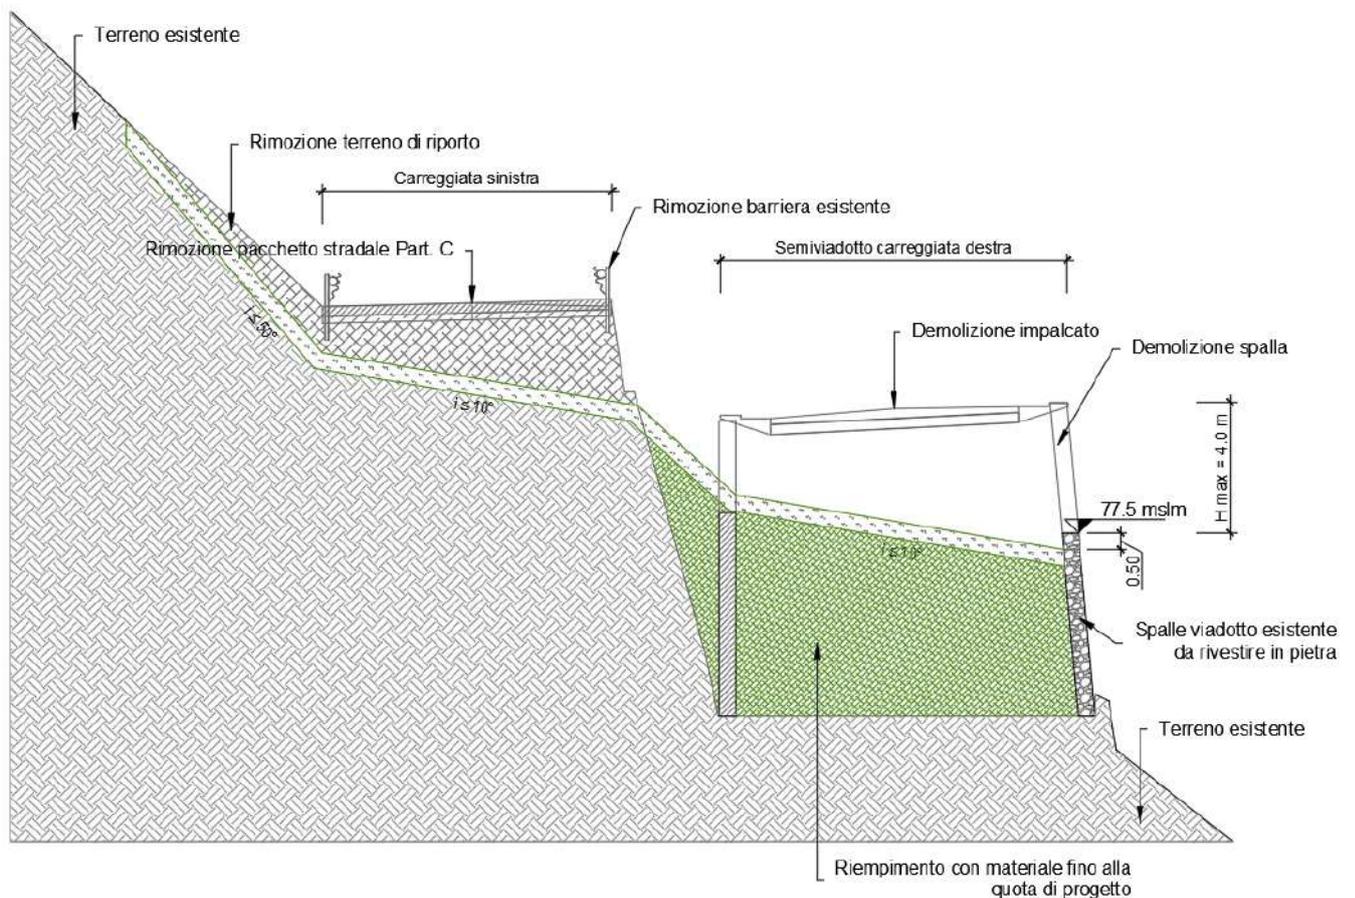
Sezione tipo D_5 semiviadotto carreggiata destra – Lotto 2b
